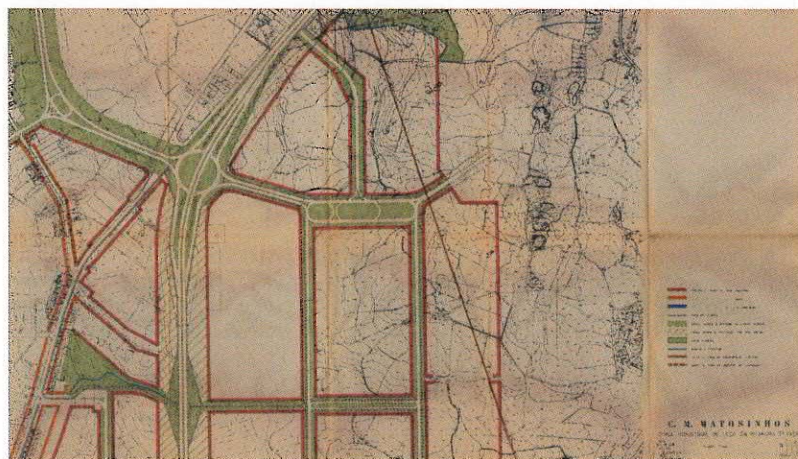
Plano da Zona Industrial de Leça, de 1964, da autoria do Arqt.º Arménio Losa
